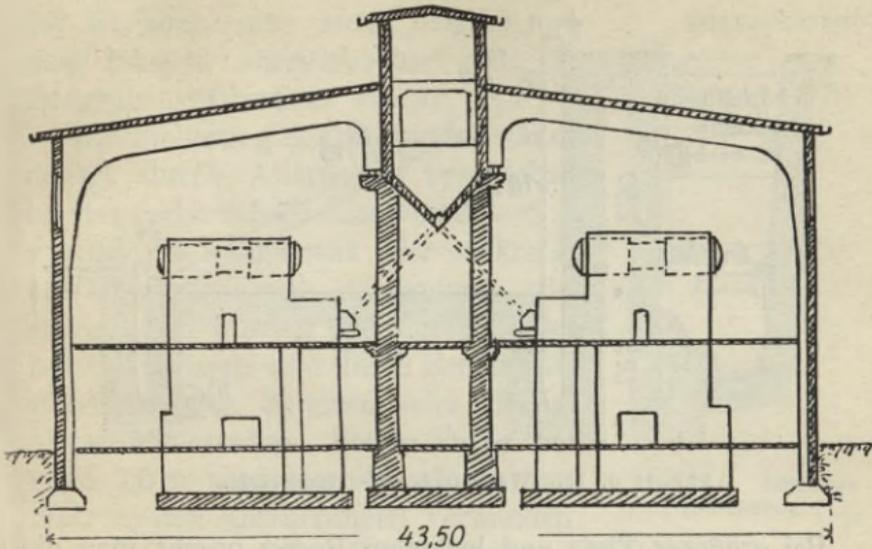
Getrennte Fundamentierung schwerer Bauteile. Kesselhaus mit Kohlenbunker.
